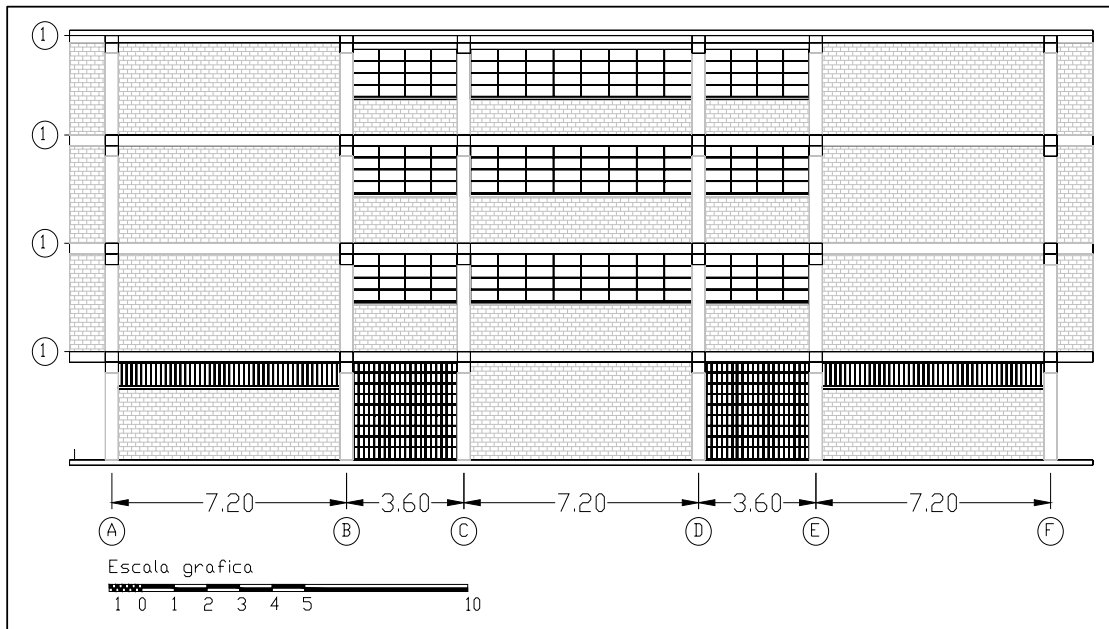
Mampostería de bloque tipo tricote / losa del nivel de techo
